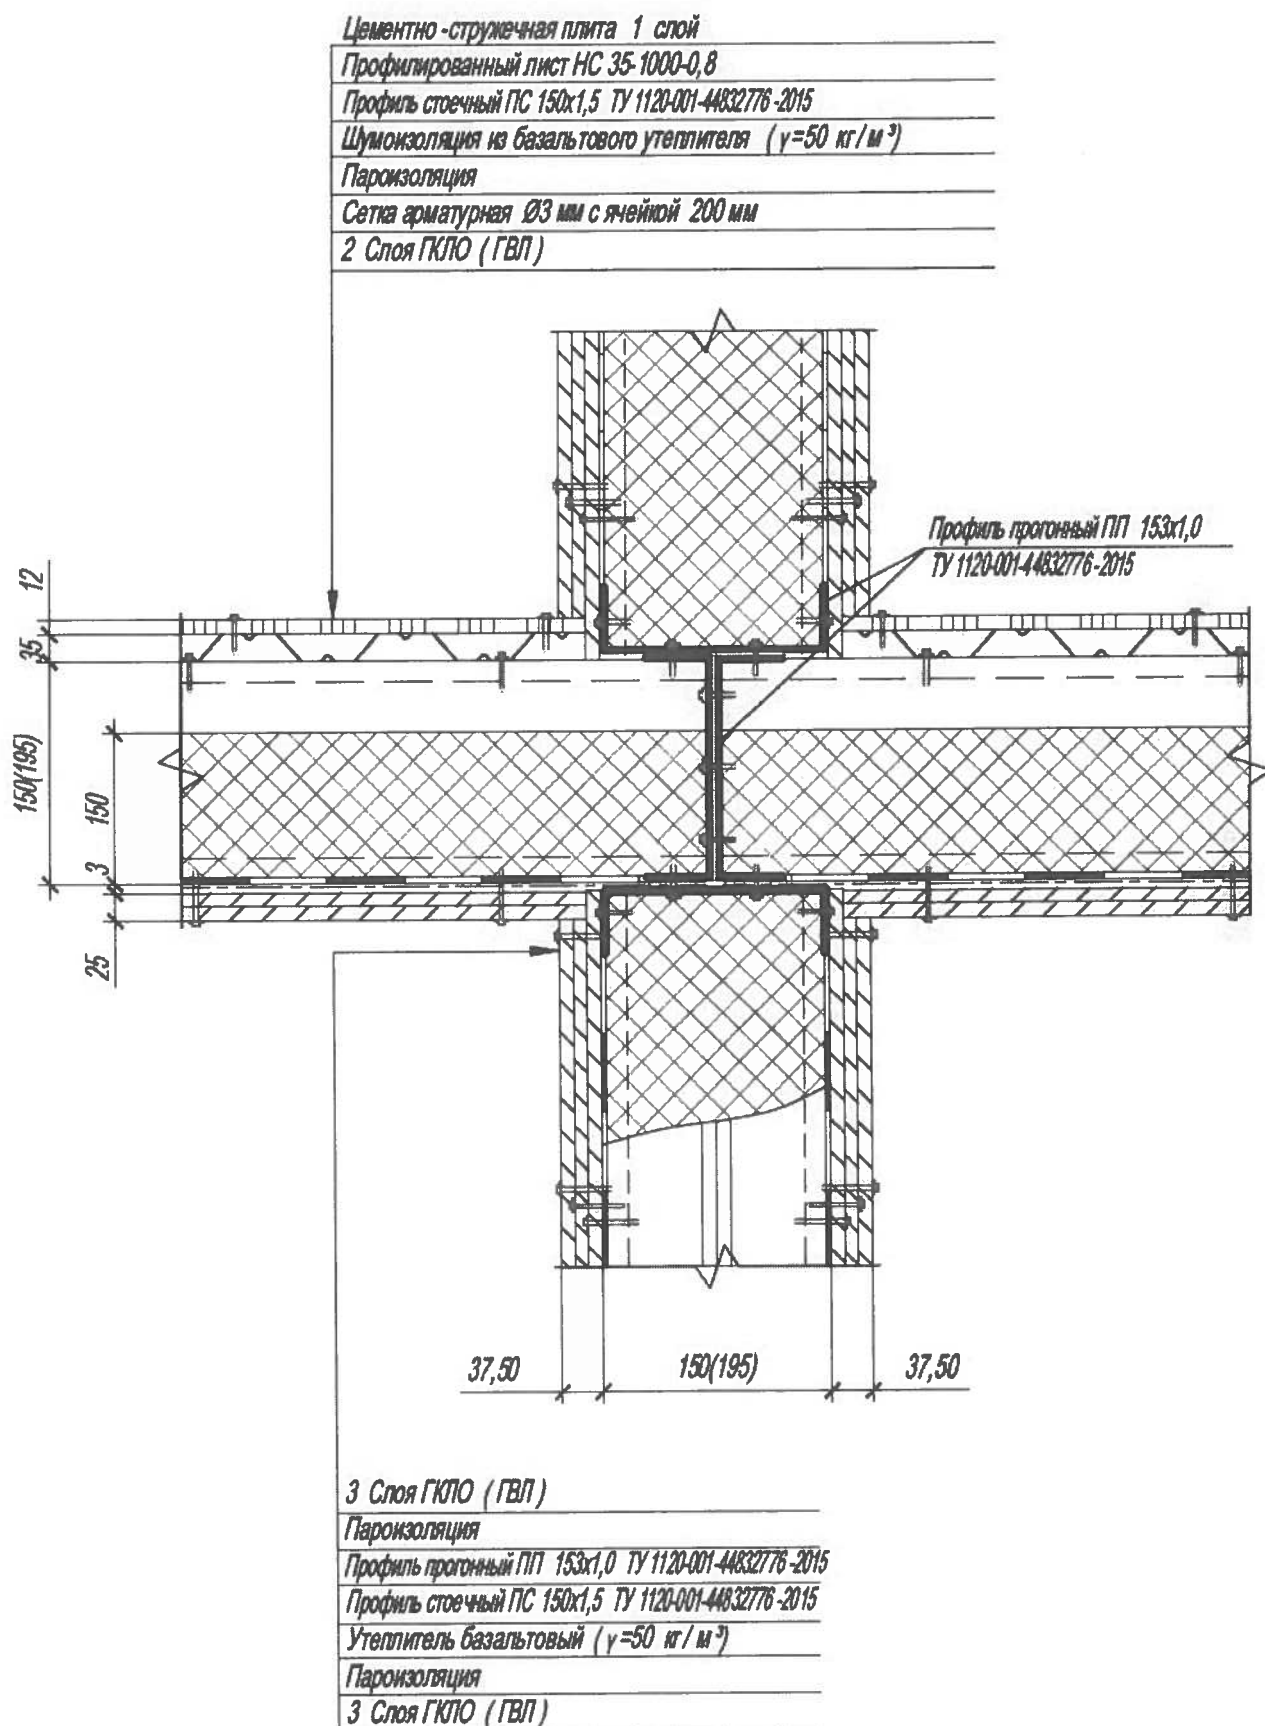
Узел крепления и опирания конструкций междуэтажных перекрытий на внутреннюю несущую стену
